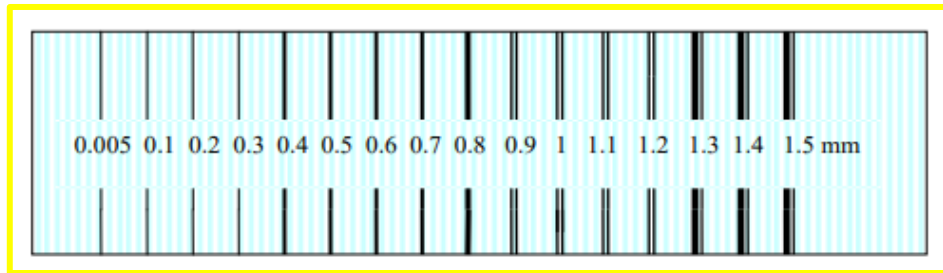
Escala de fisuras para medir ancho
